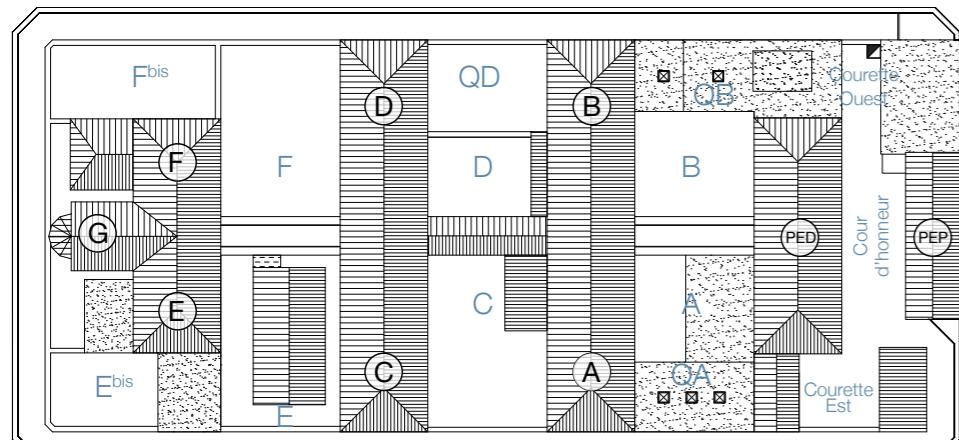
Plan de toiture existant en 2022, d'après photographie aérienne. Source : Croisée d'archi.
